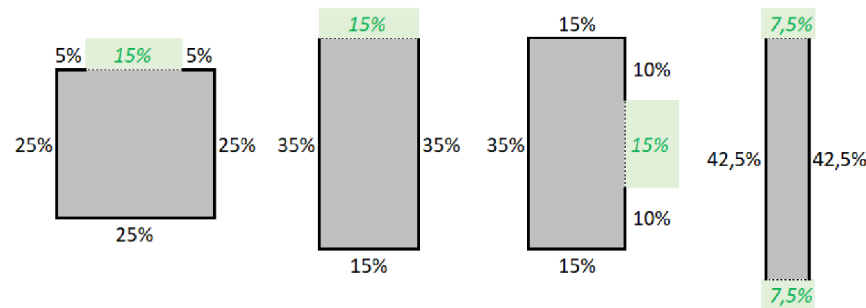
Ejemplos de localización y dimensiones mínimas (en porcentaje) de las fachadas accesibles en edificios de planta cuadrada y rectangular
